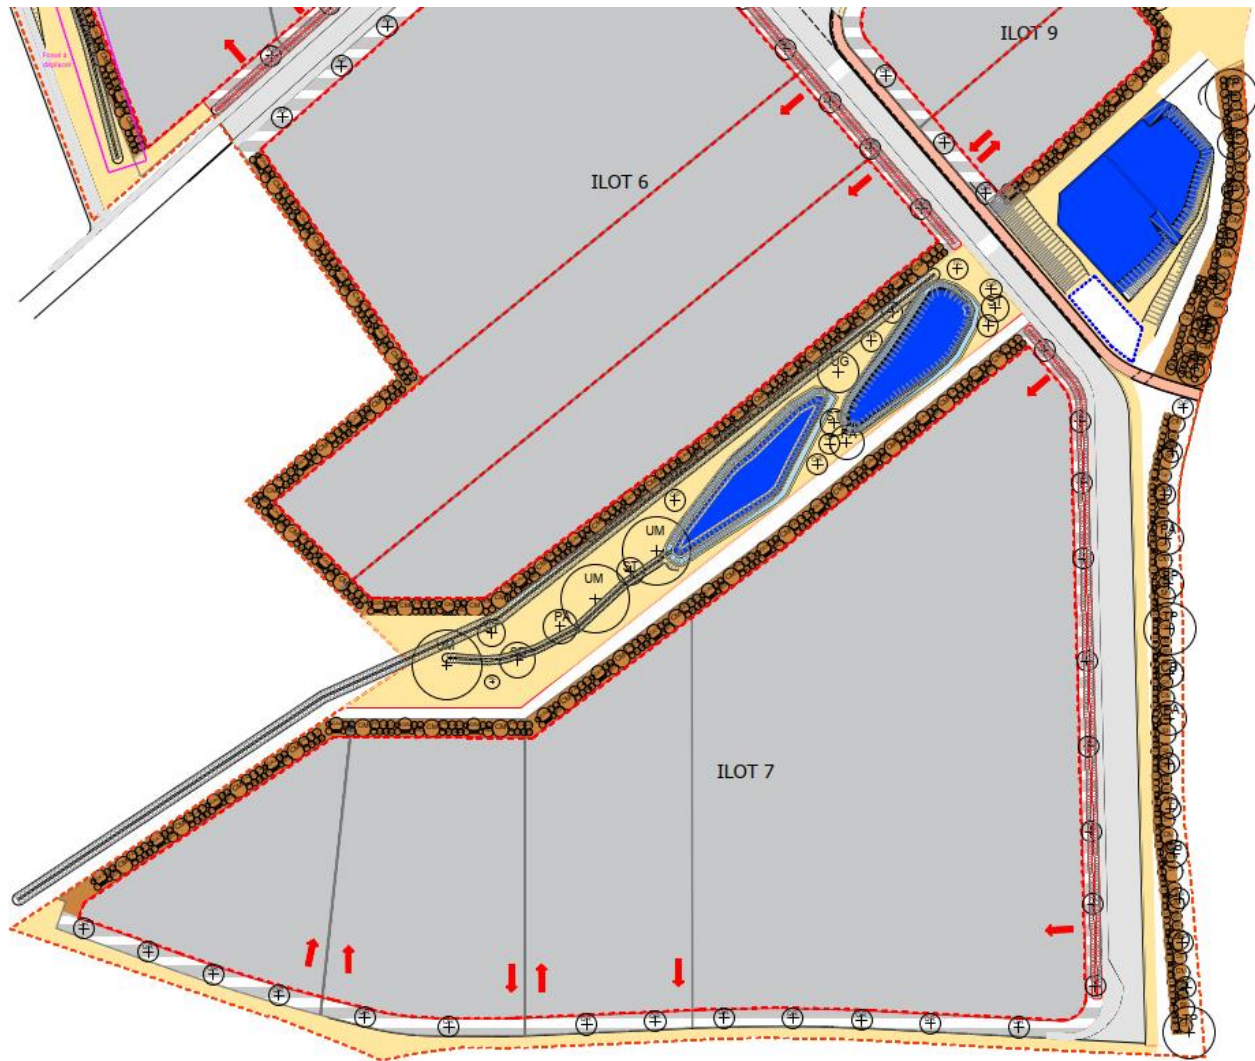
Ausschnitt Südost aus dem Plan de Plantation (Quelle: Papaya Sàrl 2025). Größere Darstellung in Anhang 06.
